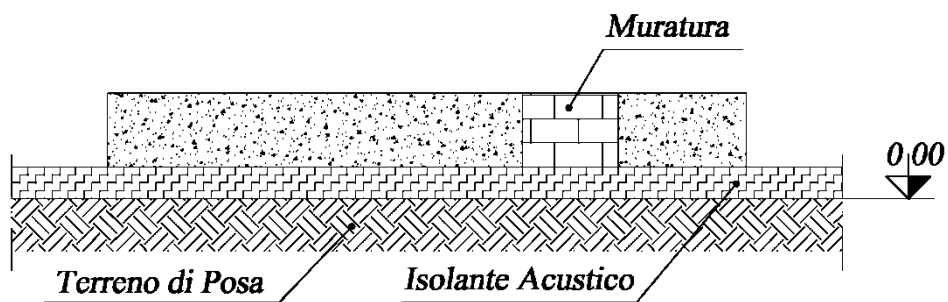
Sezione B-B della lastra di calcestruzzo (Monteforte, 1998).
